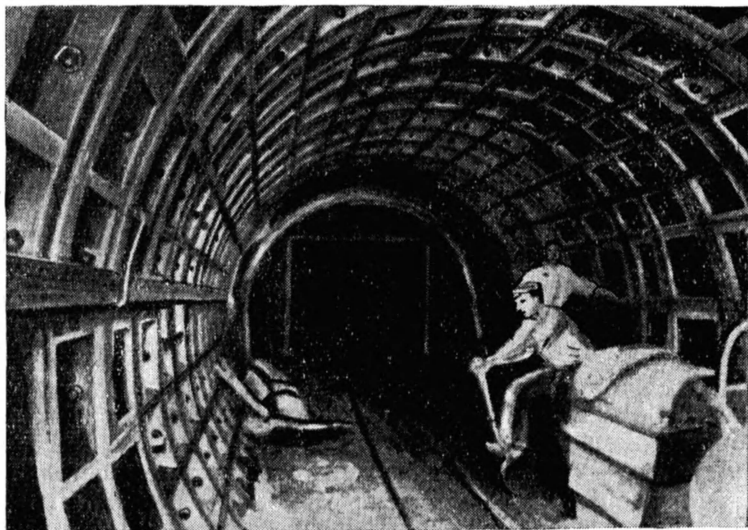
Перегонный тоннель Лондонского метрополитена с обделкой из железобетонных тюбингов
